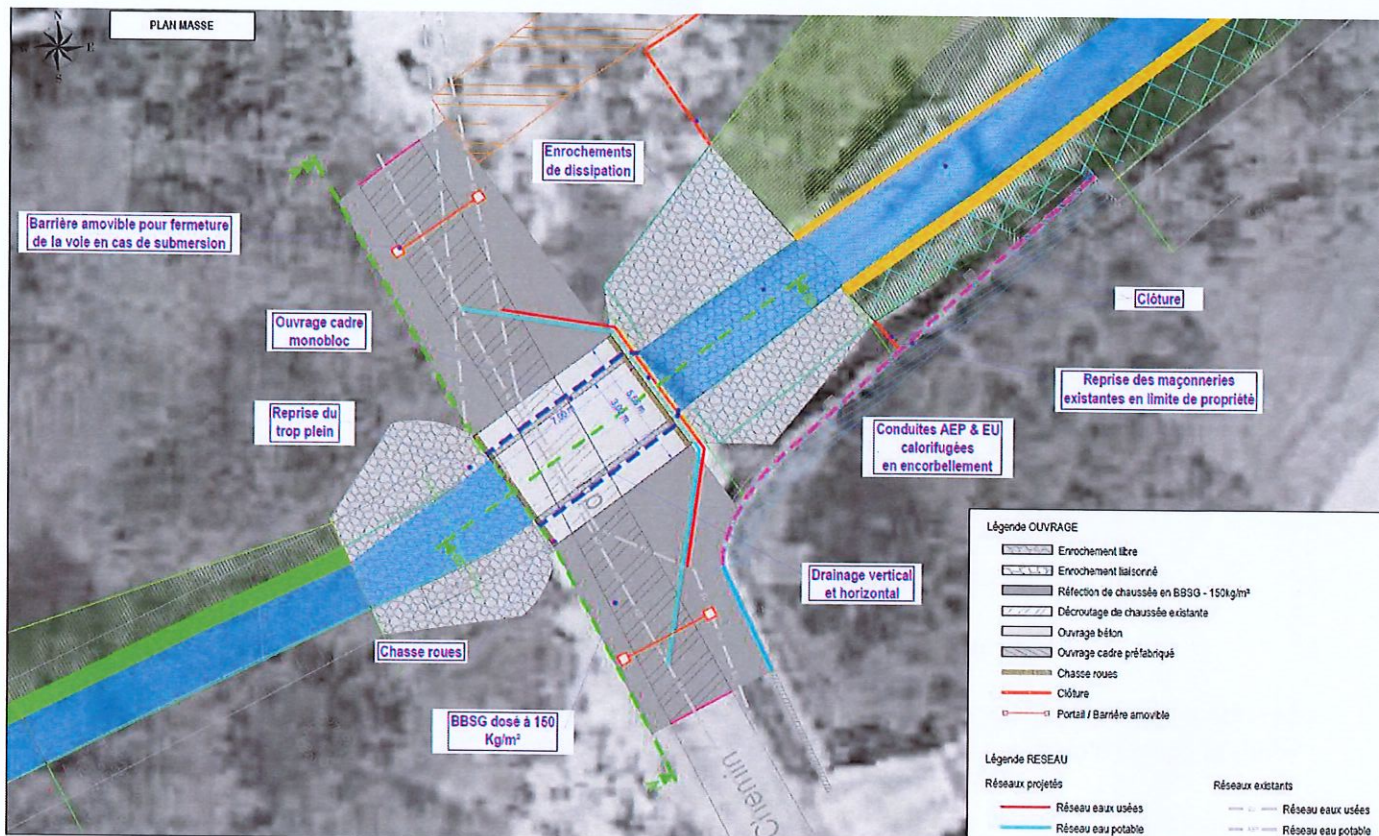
plan de dévoiement des réseaux chemin de la Condamine
